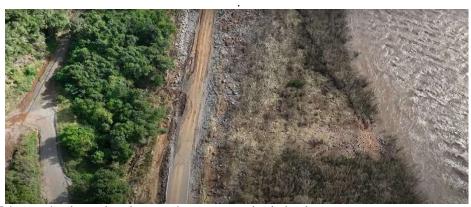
pavimentação arrancada e sistema de drenagem destruído. É necessária a repavimentação do trecho de 394,20 m, com 10 de largura, com reforço do subleito. Também é necessária a reconstrução de 03 bueiros, com diâmetro de 100 cm, execução de sarjetas SZC-9030 e 03 caixas coletoras de sarjeta CCS-19.
